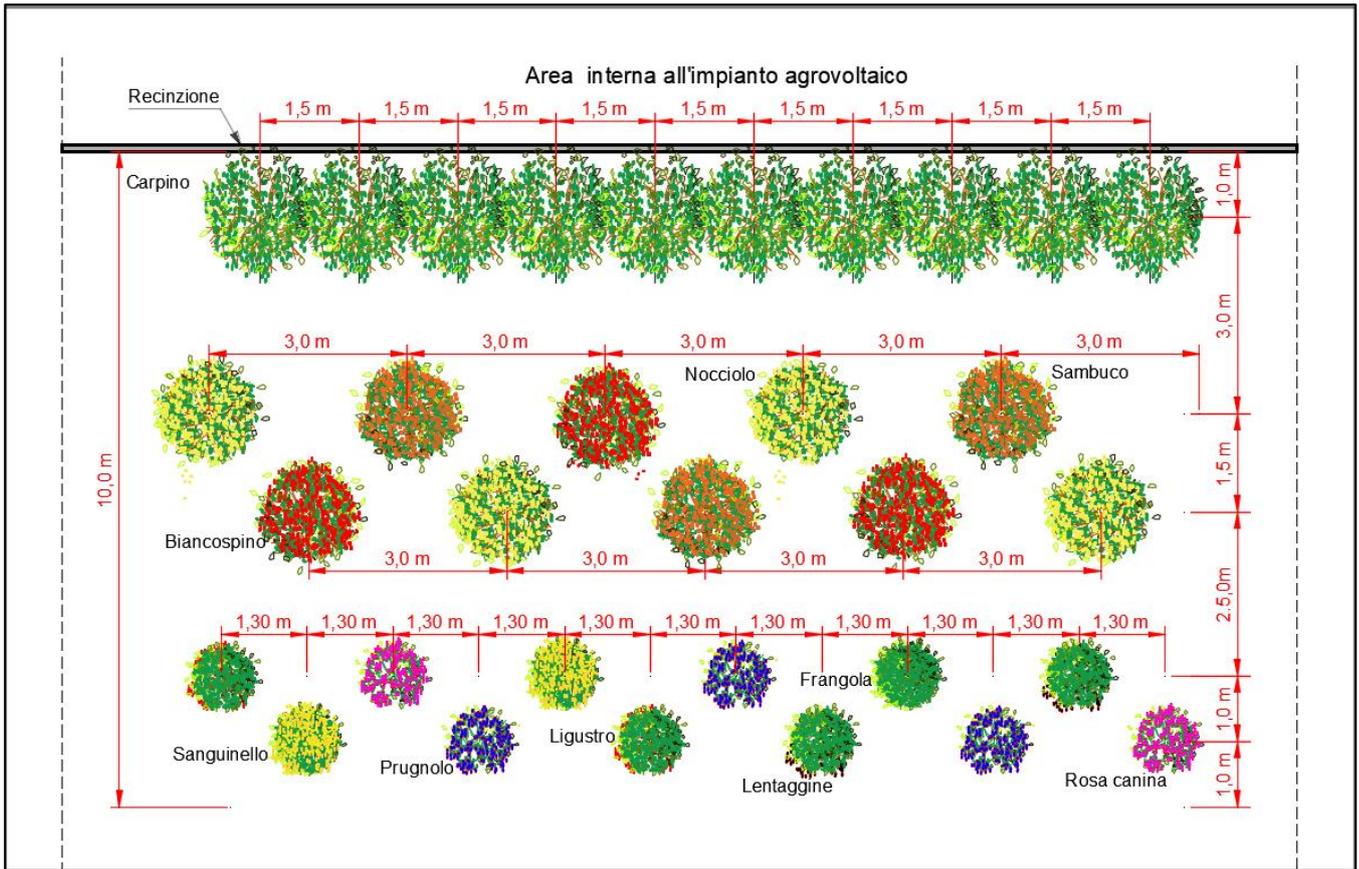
Rappresentazione della fascia perimetrale di mitigazione visiva: Area della biodiversità - vista in pianta
